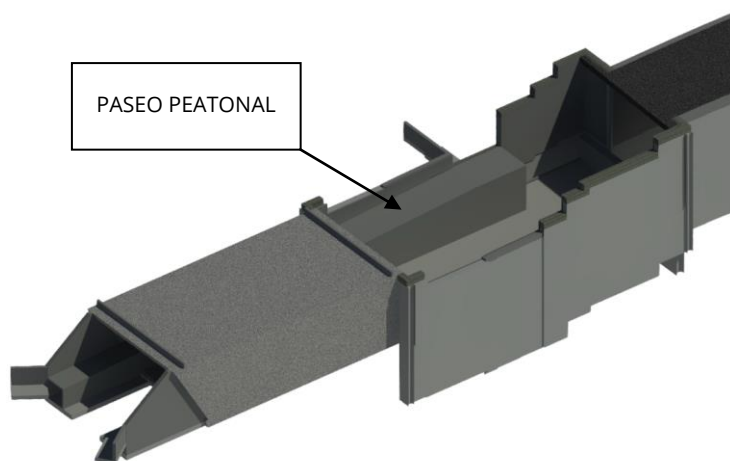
Ubicación de la losa y muro para paseo peatonal
